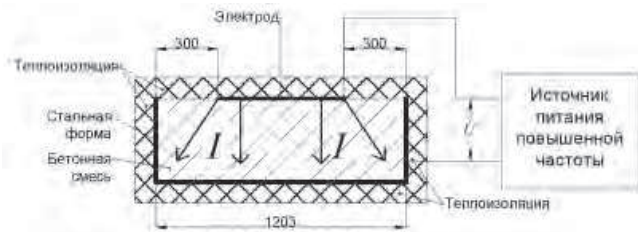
Схема электротепловой обработки бетона с органическим наполнителем (лен, конопля)
